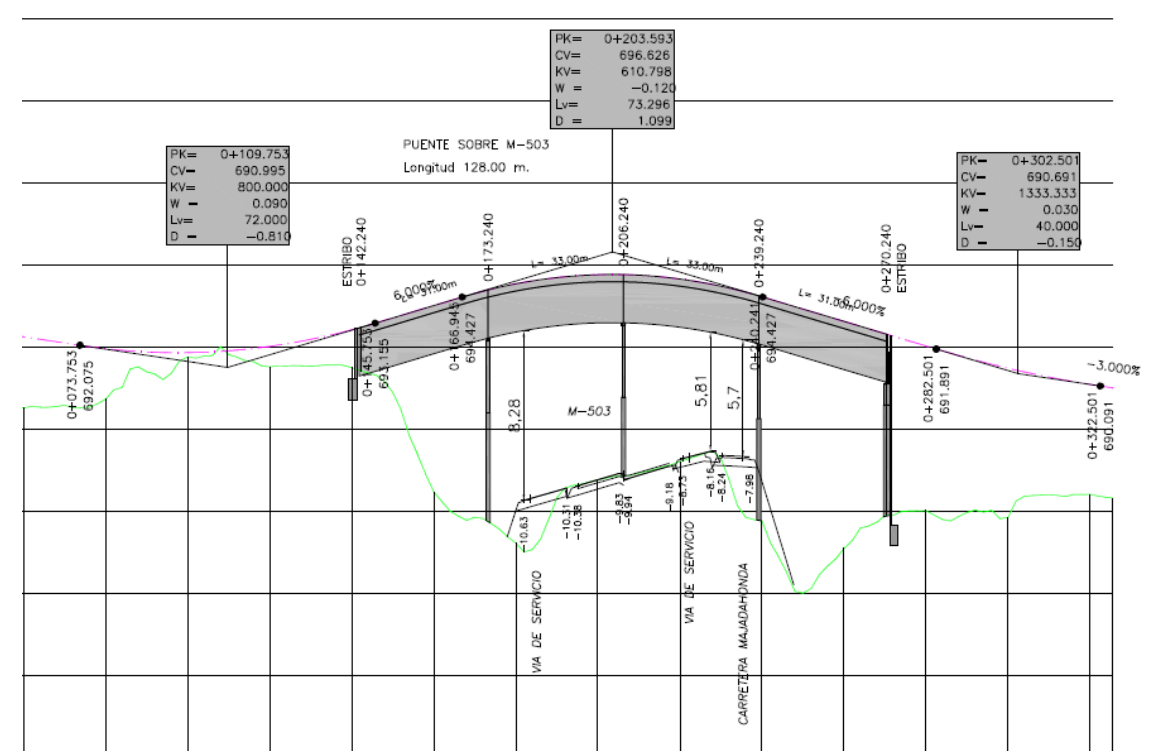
Perfil longitudinal ESTRUCTURA 3
